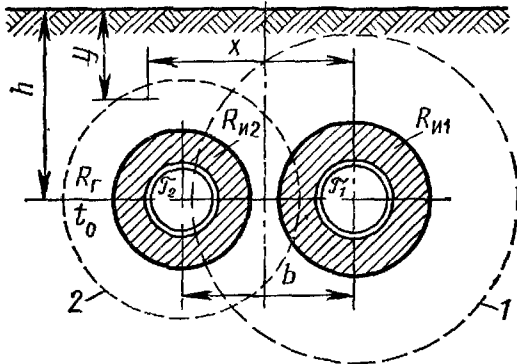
Расчетная схема бесканального двухтрубного теплопровода
